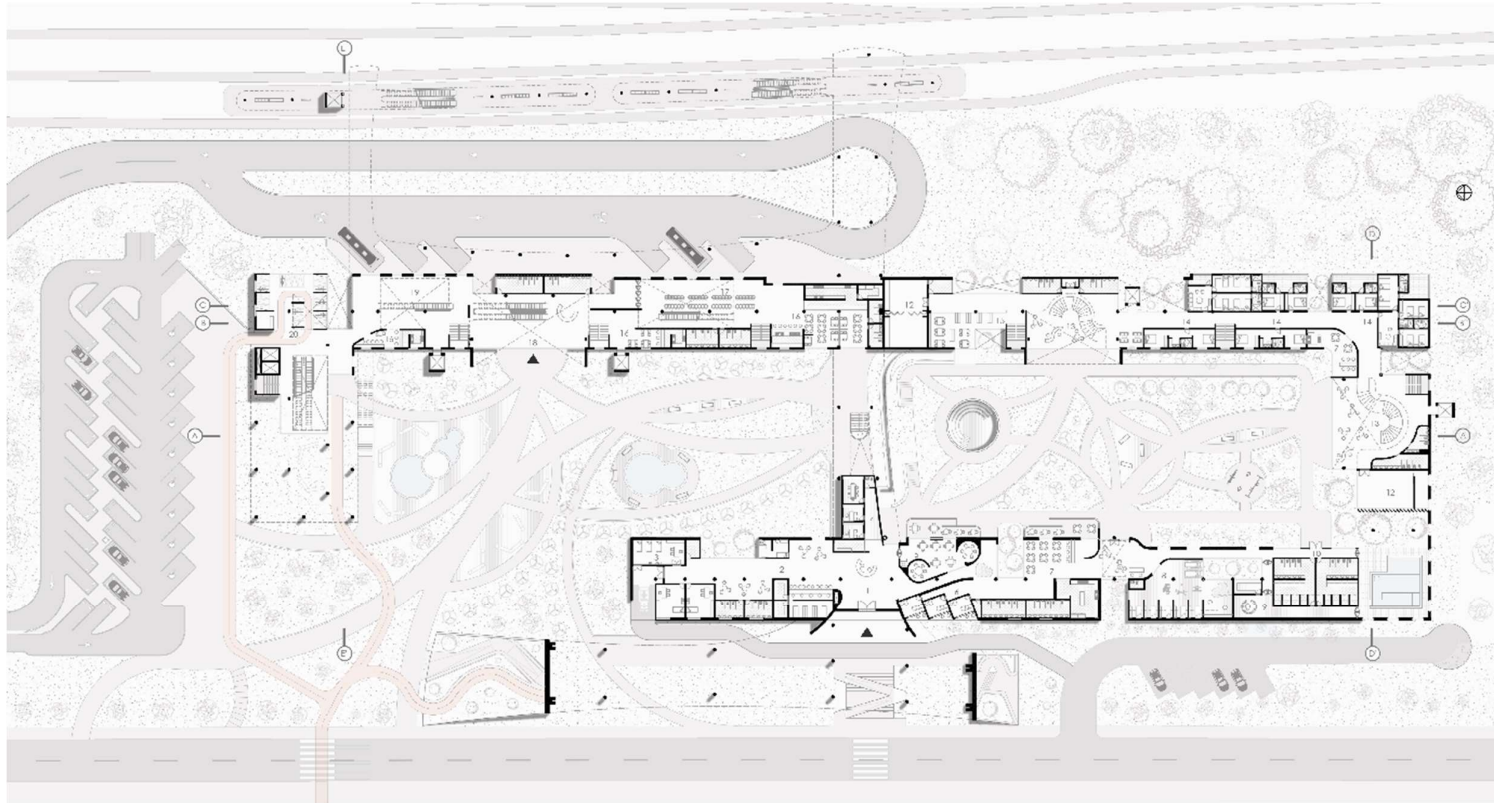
Planta baja, N. +0.00. Elaborado por Kevin J. Enriquez
